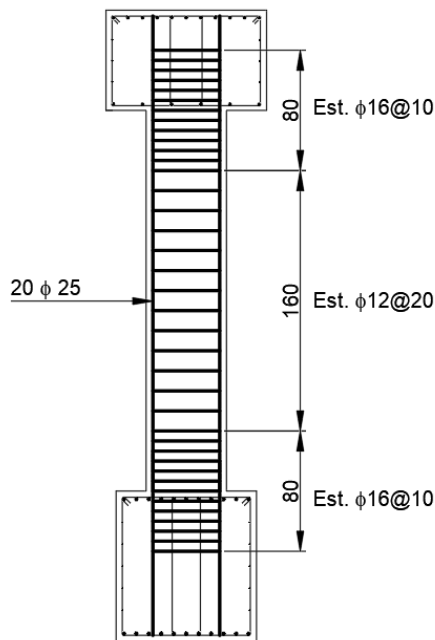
Armadura de diseño de las columnas (dimensiones en cm).
